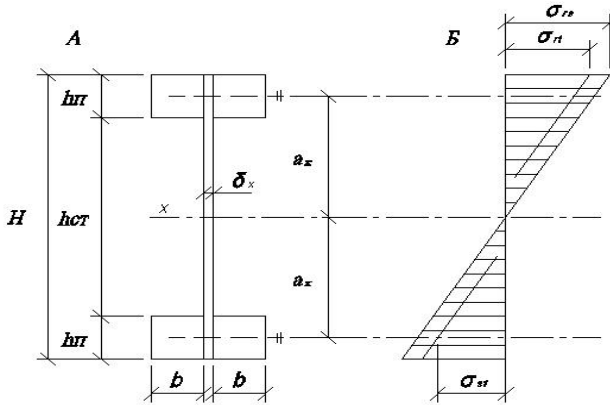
Данные к расчету. А- поперечное сечение составной двутавровой балки; Б- эпюра нормальных напряжений в поперечном сечении составной двутавровой балки.
